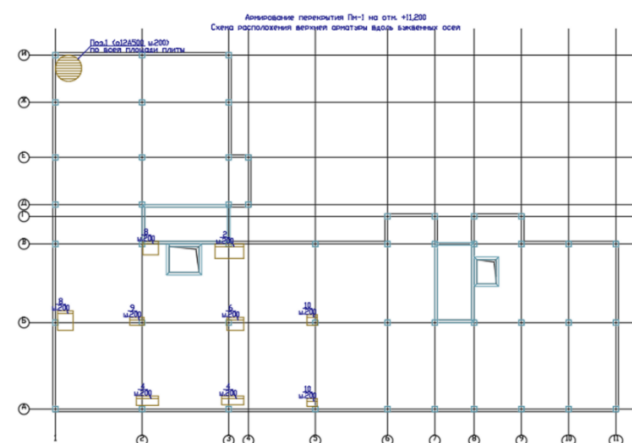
Верхнее армирование плиты по оси X в ПК Лира-САПР
